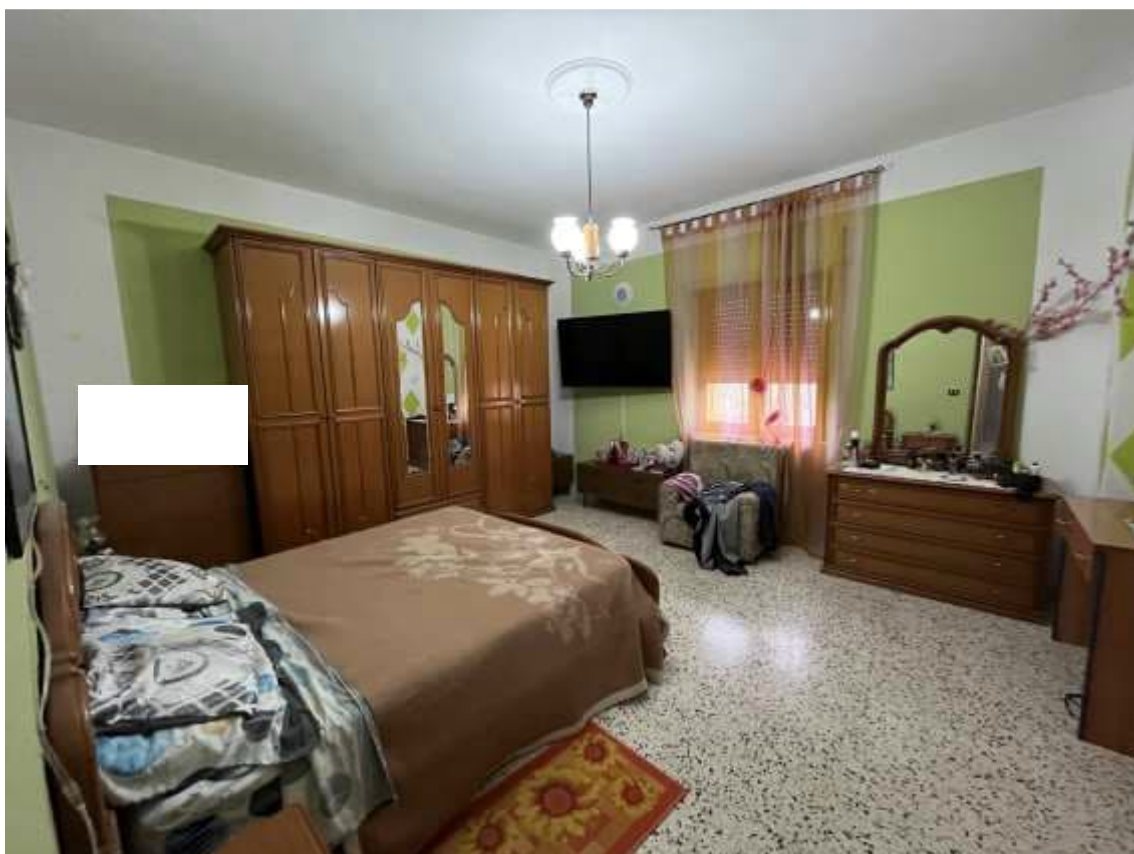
Vista vano camera da letto posto sul fronte ovest del sub.2 - P1
